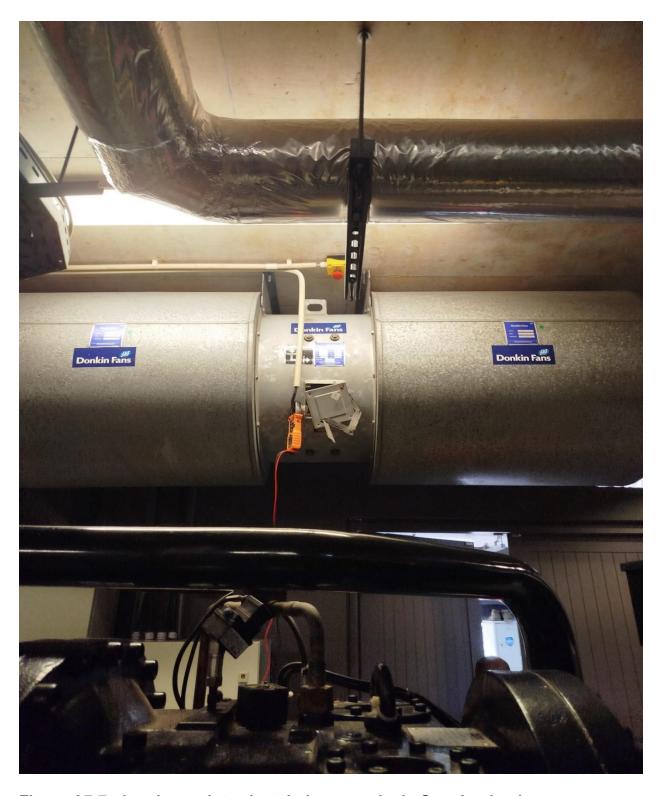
tipo de condutas instaladas na sede do Standart bank
